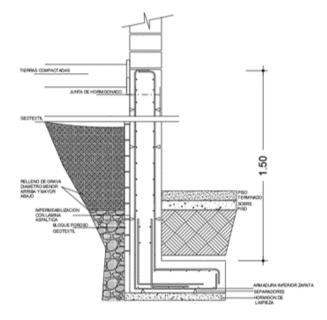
Detalle de muro de contención propuesto en el bloque 1.
